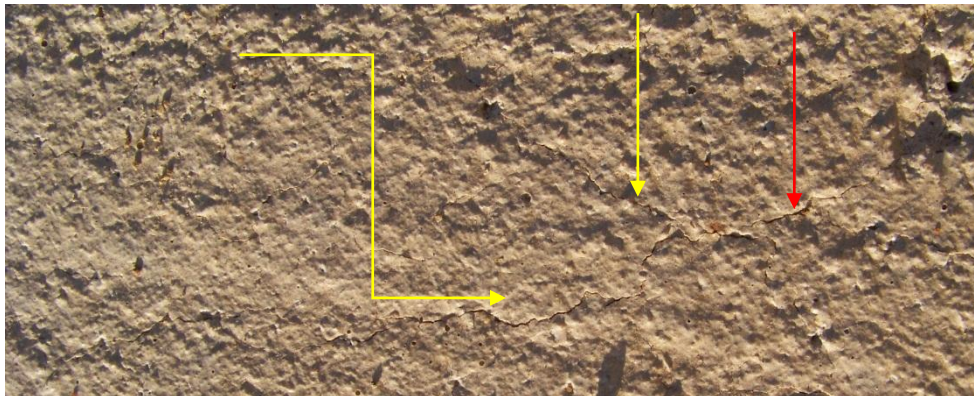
Placa A1 – Concreto referência (sem fibras) – Início do monitoramento do aparecimento de fissuras por retração plástica (primeiras horas após a concretagem). Data: 28 de agosto de 2012. Fonte: Autor.
